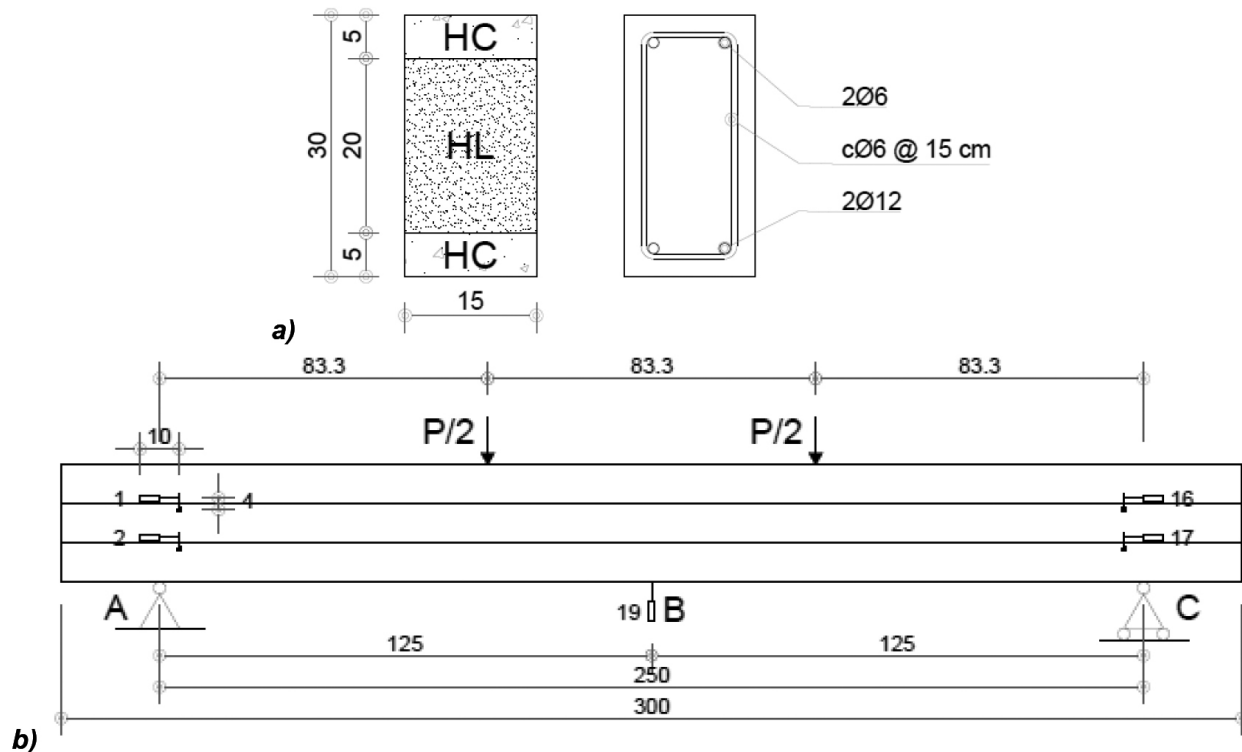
a) Sección tipo de la viga y su armado y b) distribución de cargas y sensores
